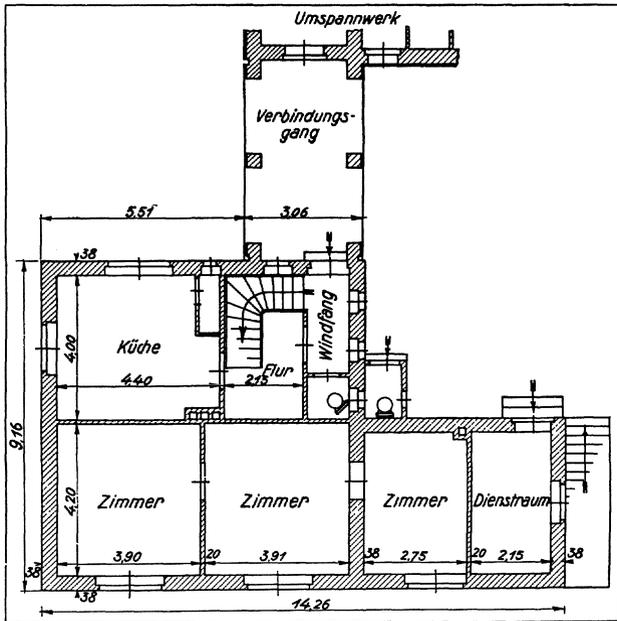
Grundriß eines Schaltwärterwohnhauses (Abb. 390).
